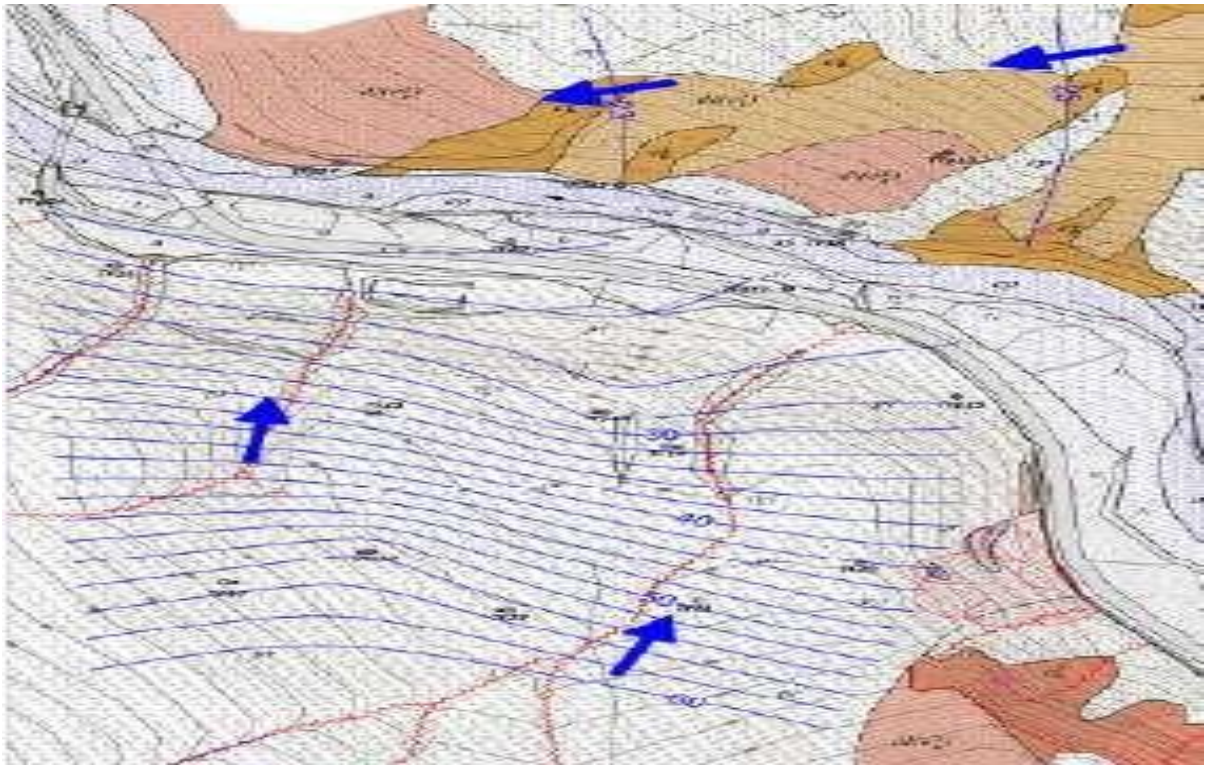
Position des niveaux des aquifères dans la zone du site du barrage de Tarzout[5]
